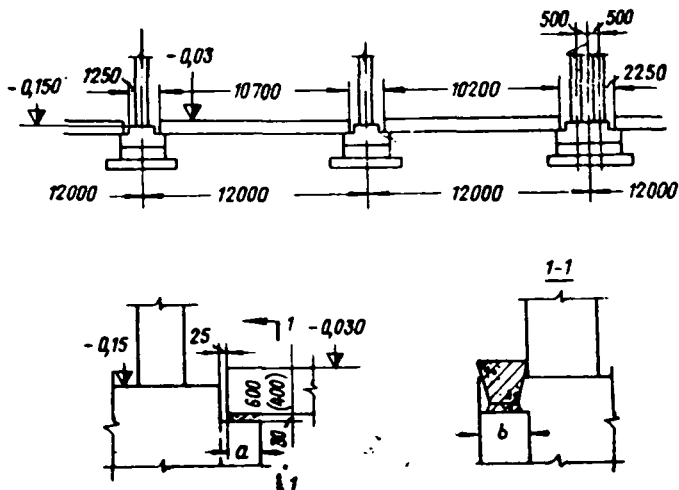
Схема опирания фундаментных балок при шаге колонн 12 м
